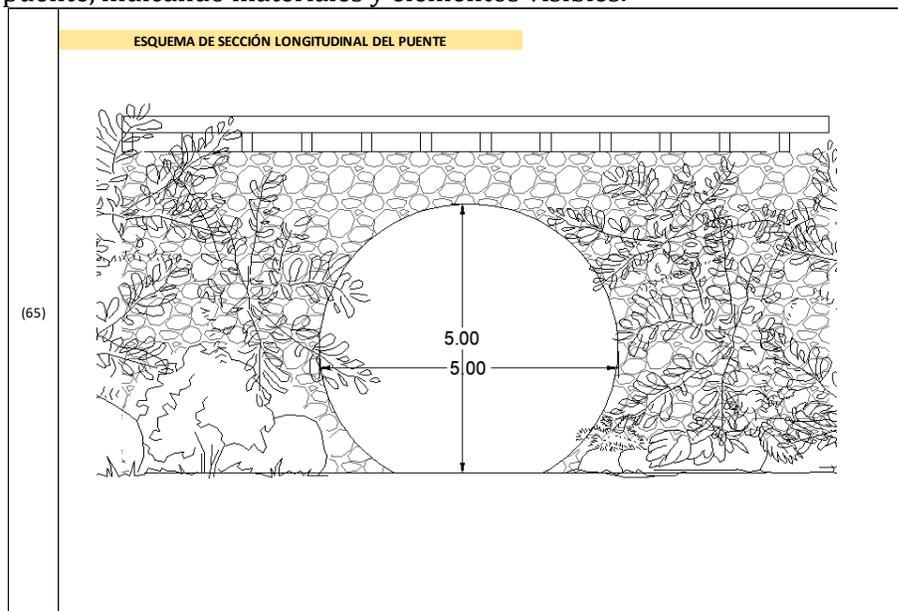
Ejemplo de esquema de sección longitudinal de un puente Súper Span.
